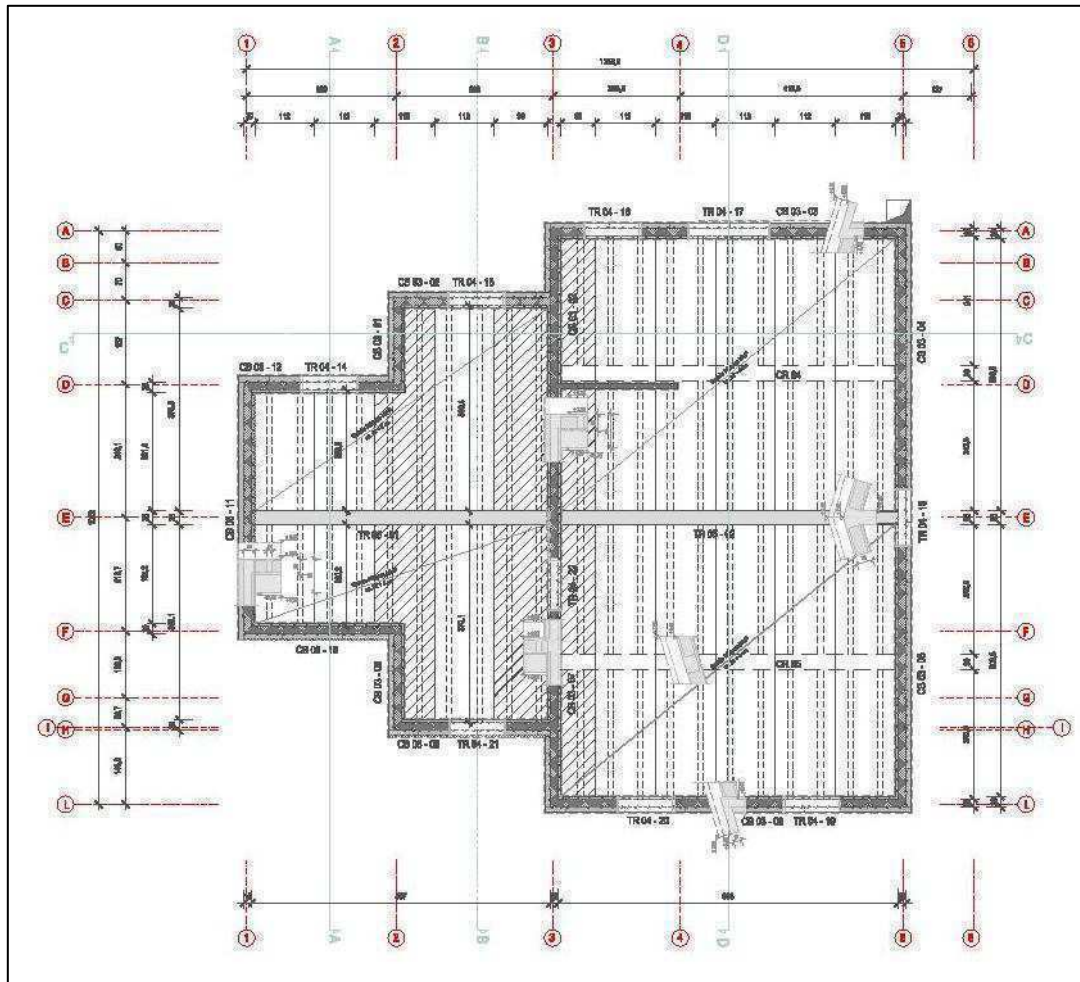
Pianta Piano Primo – Solai – Carpenterie; Tavola 6.
